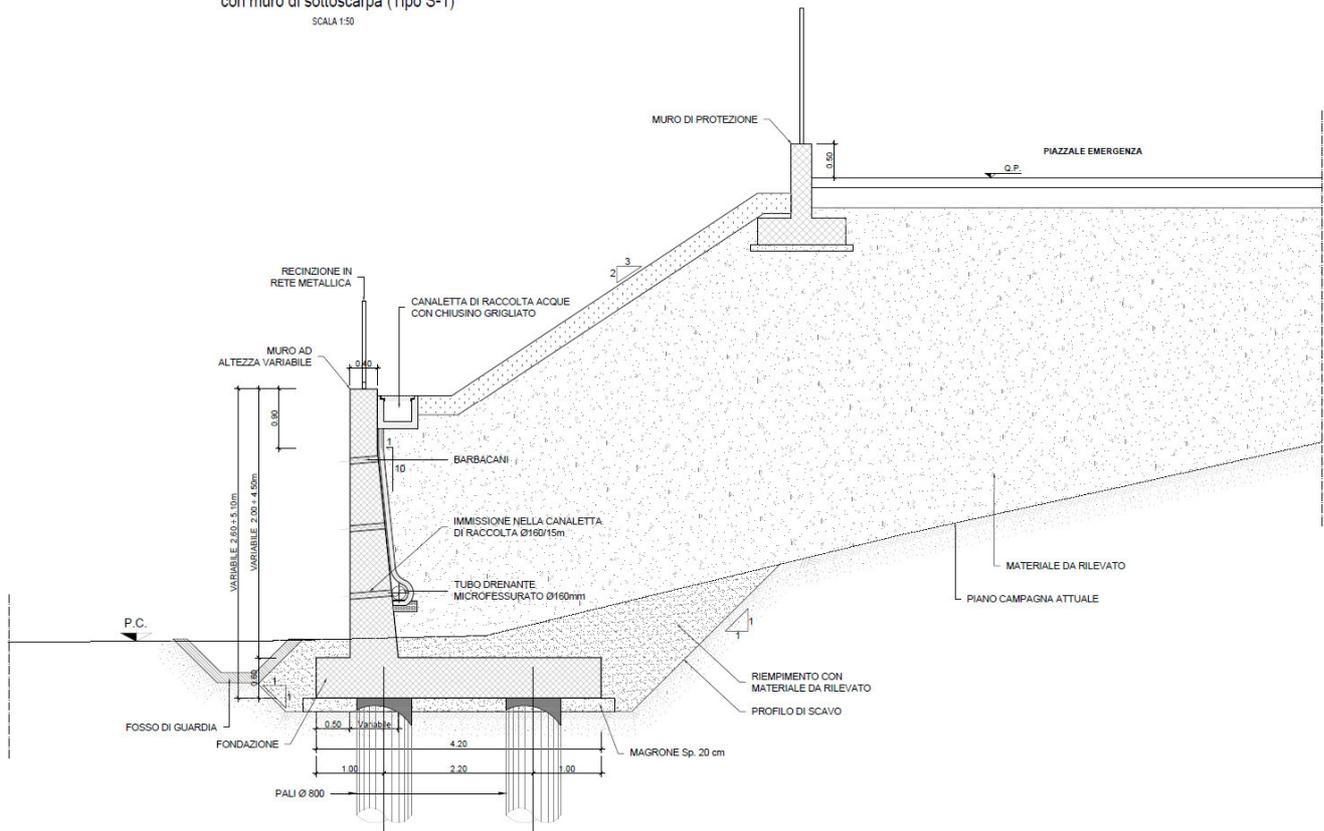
Sezione tipo piazzali con muro di sottoscarpa (tipo S-1)
